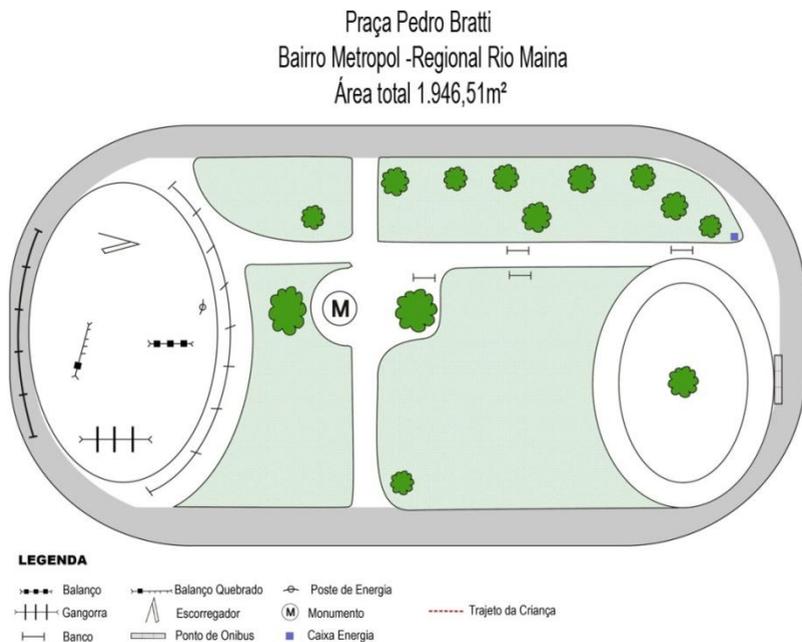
Planta baixa da Praça Pedro Bratti.
